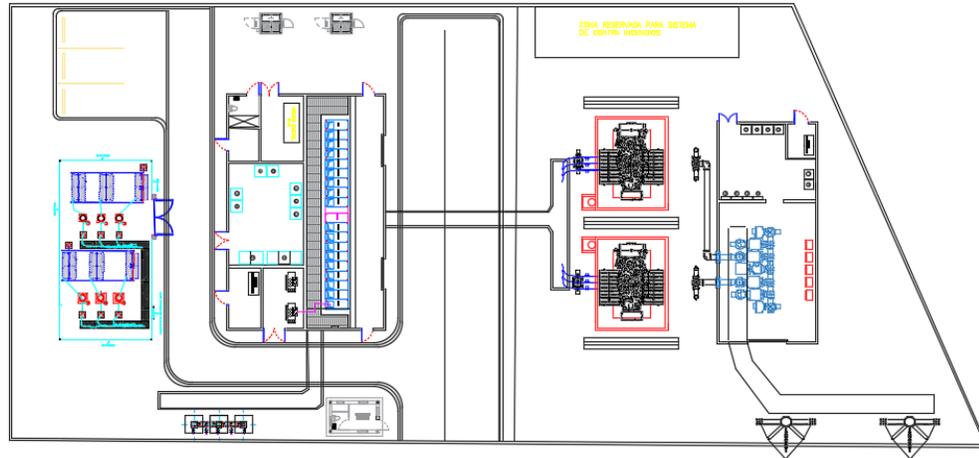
Vista en Planta Subestación Centro de Operaciones
